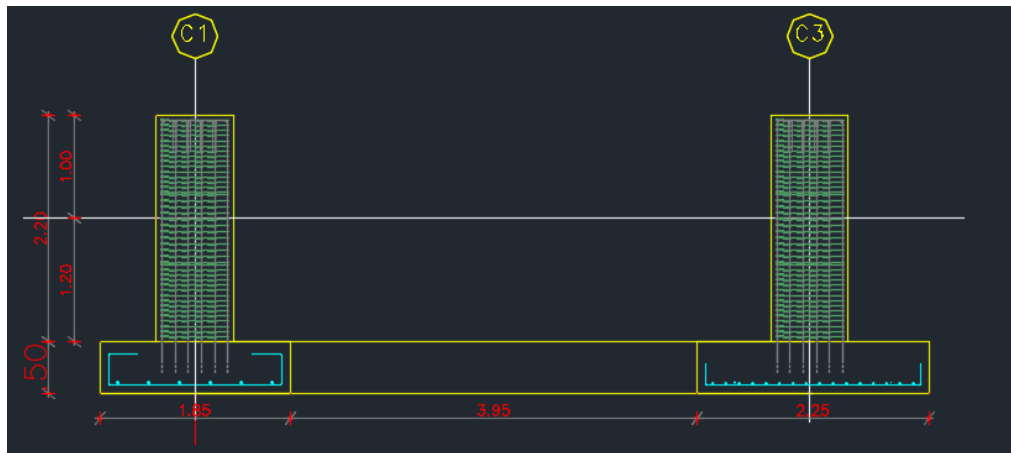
Vista en perfil Estructura metálica Escenario Deportivo Chamicueto. Fuente: planos estructurales
